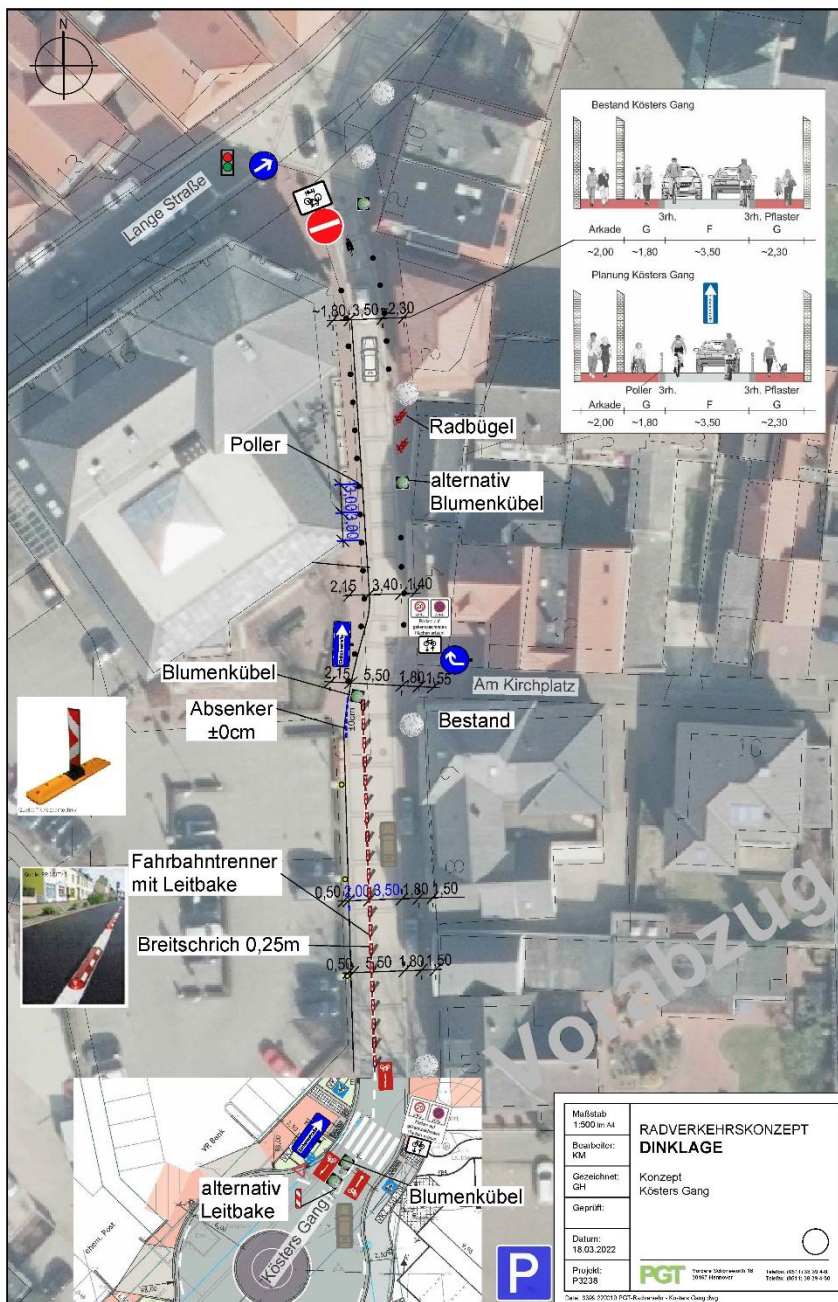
Kösters Gang – Planung Pilotversuch
